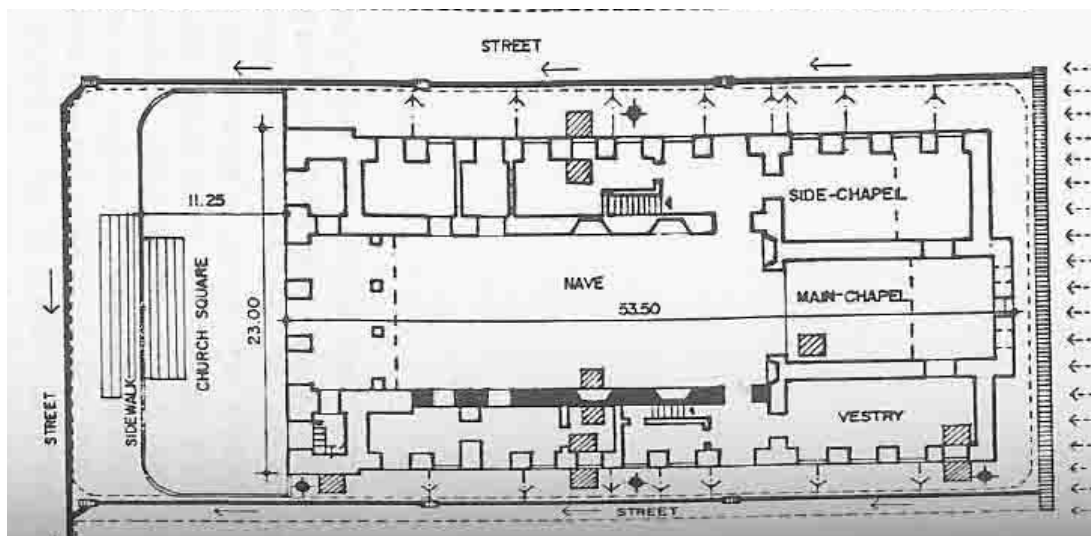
Planta do pavimento térreo da N. S. do Pilar, São João Del Rei (MG)
